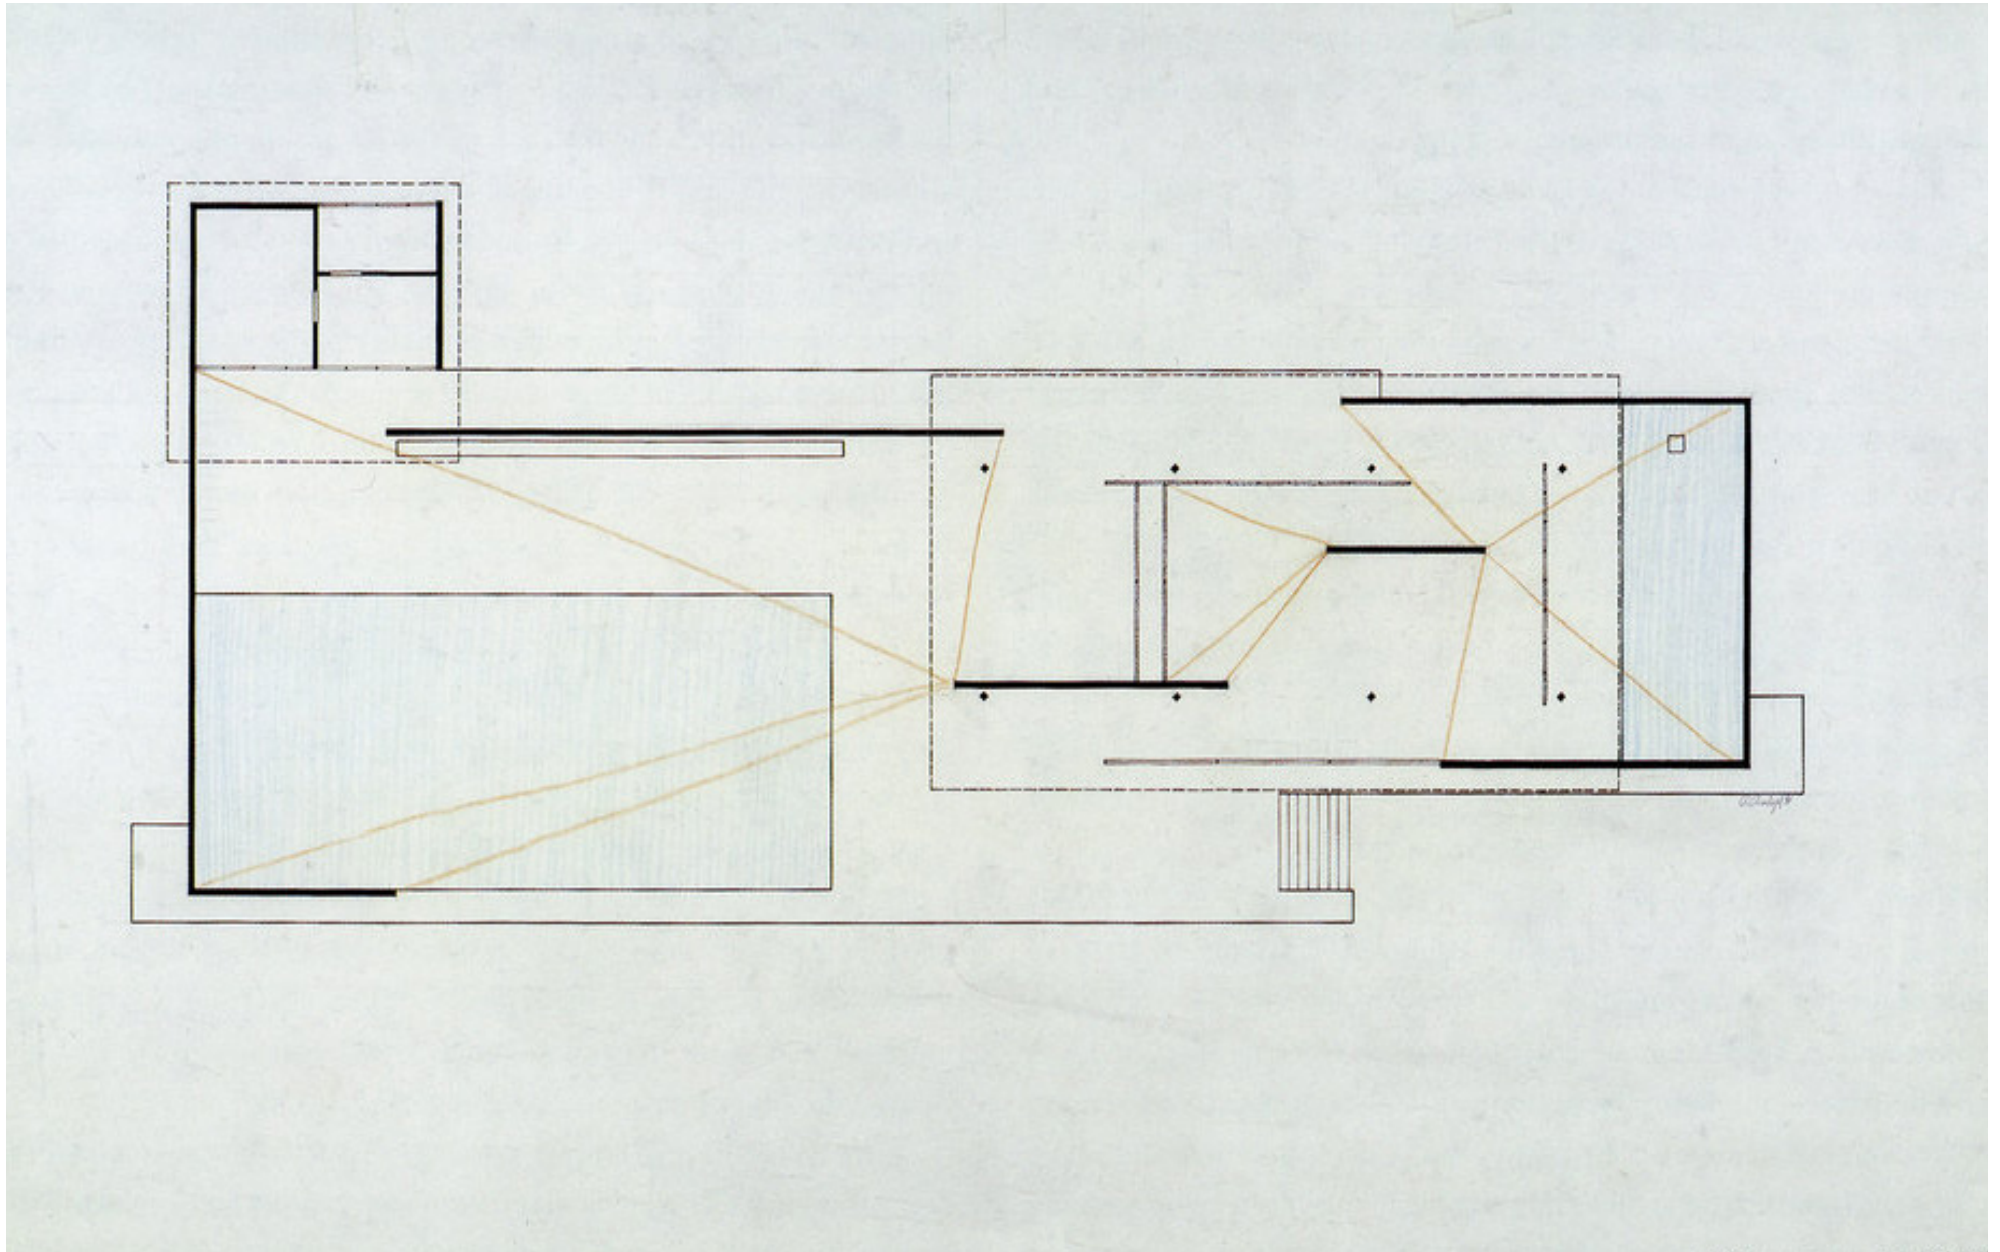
Análisis del espacio arquitectónico modificado por planos transparente
